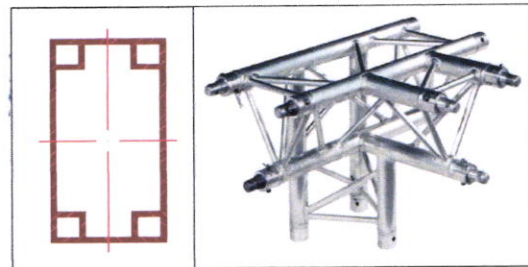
poteau tridimensionnel ; source : auteurs 2018.
